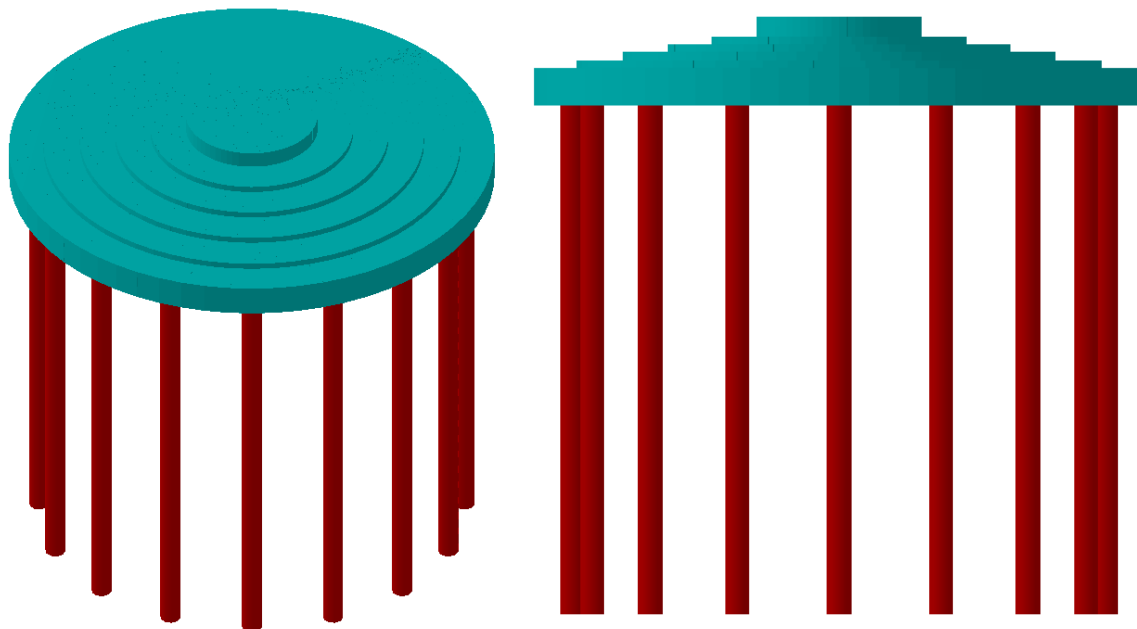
Vista 3D e vista XZ fondazione tipo.
